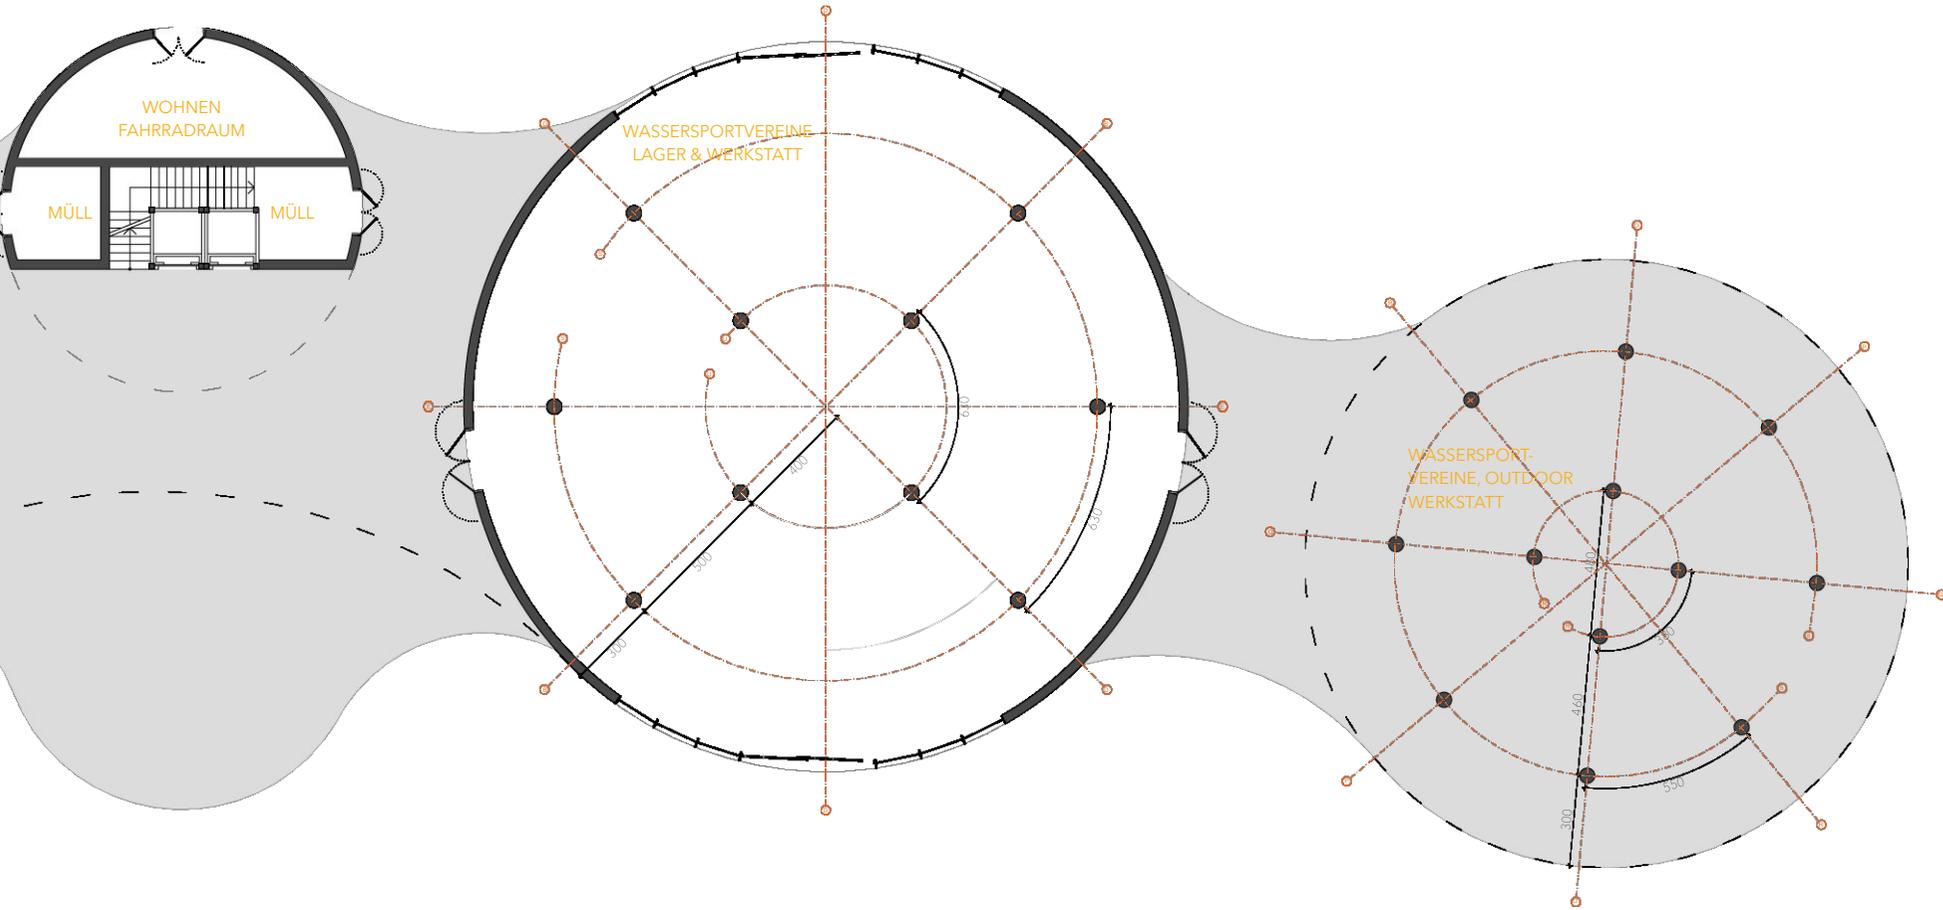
Grundriss EG mit Achsenraster
